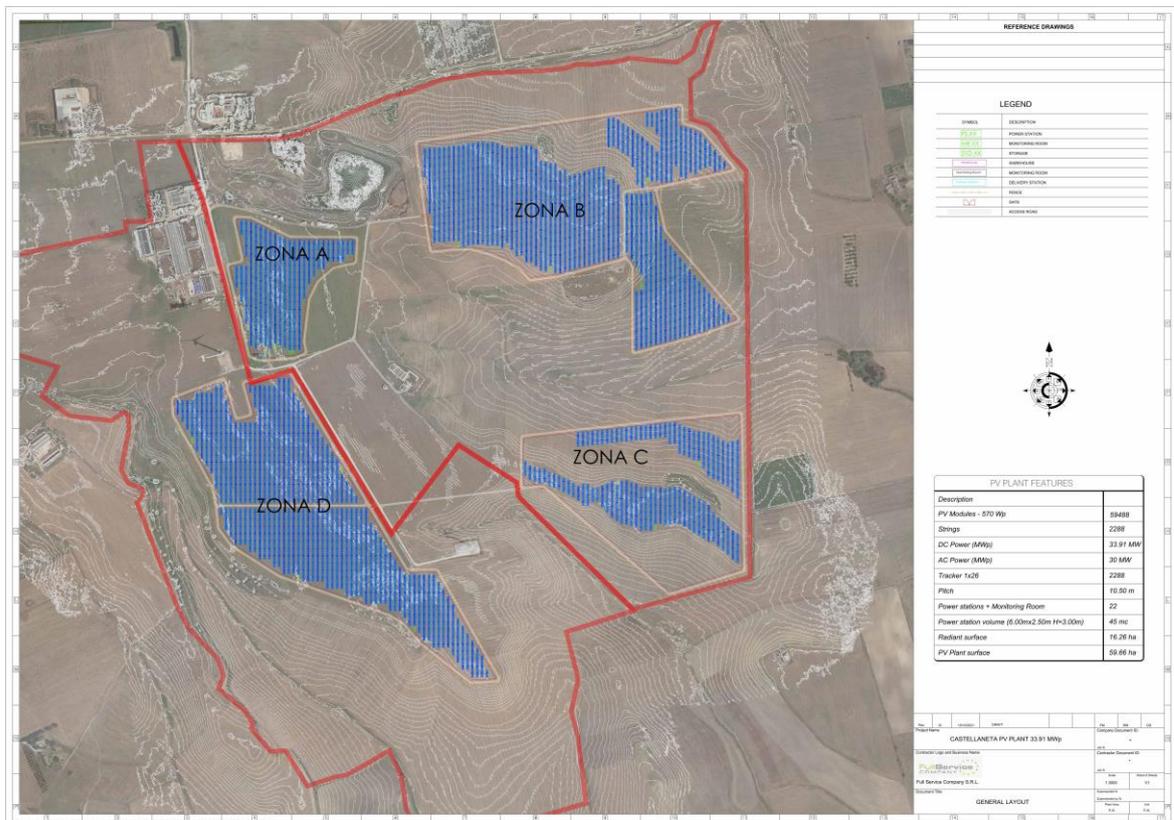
Layout impianto agri-fotovoltaico in progetto.
